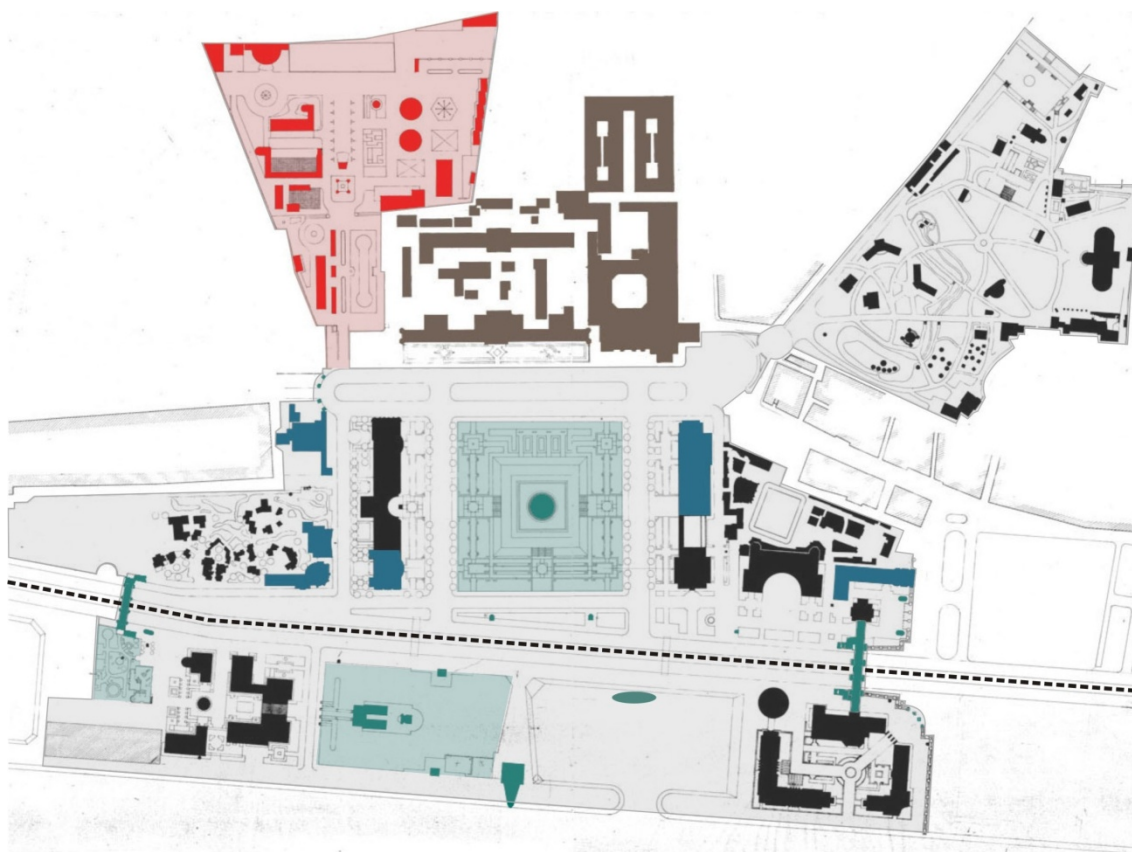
| PLANTA DA EXPOSIÇÃO. OUTROS NÚCLEOS E PAVILHÕES.
